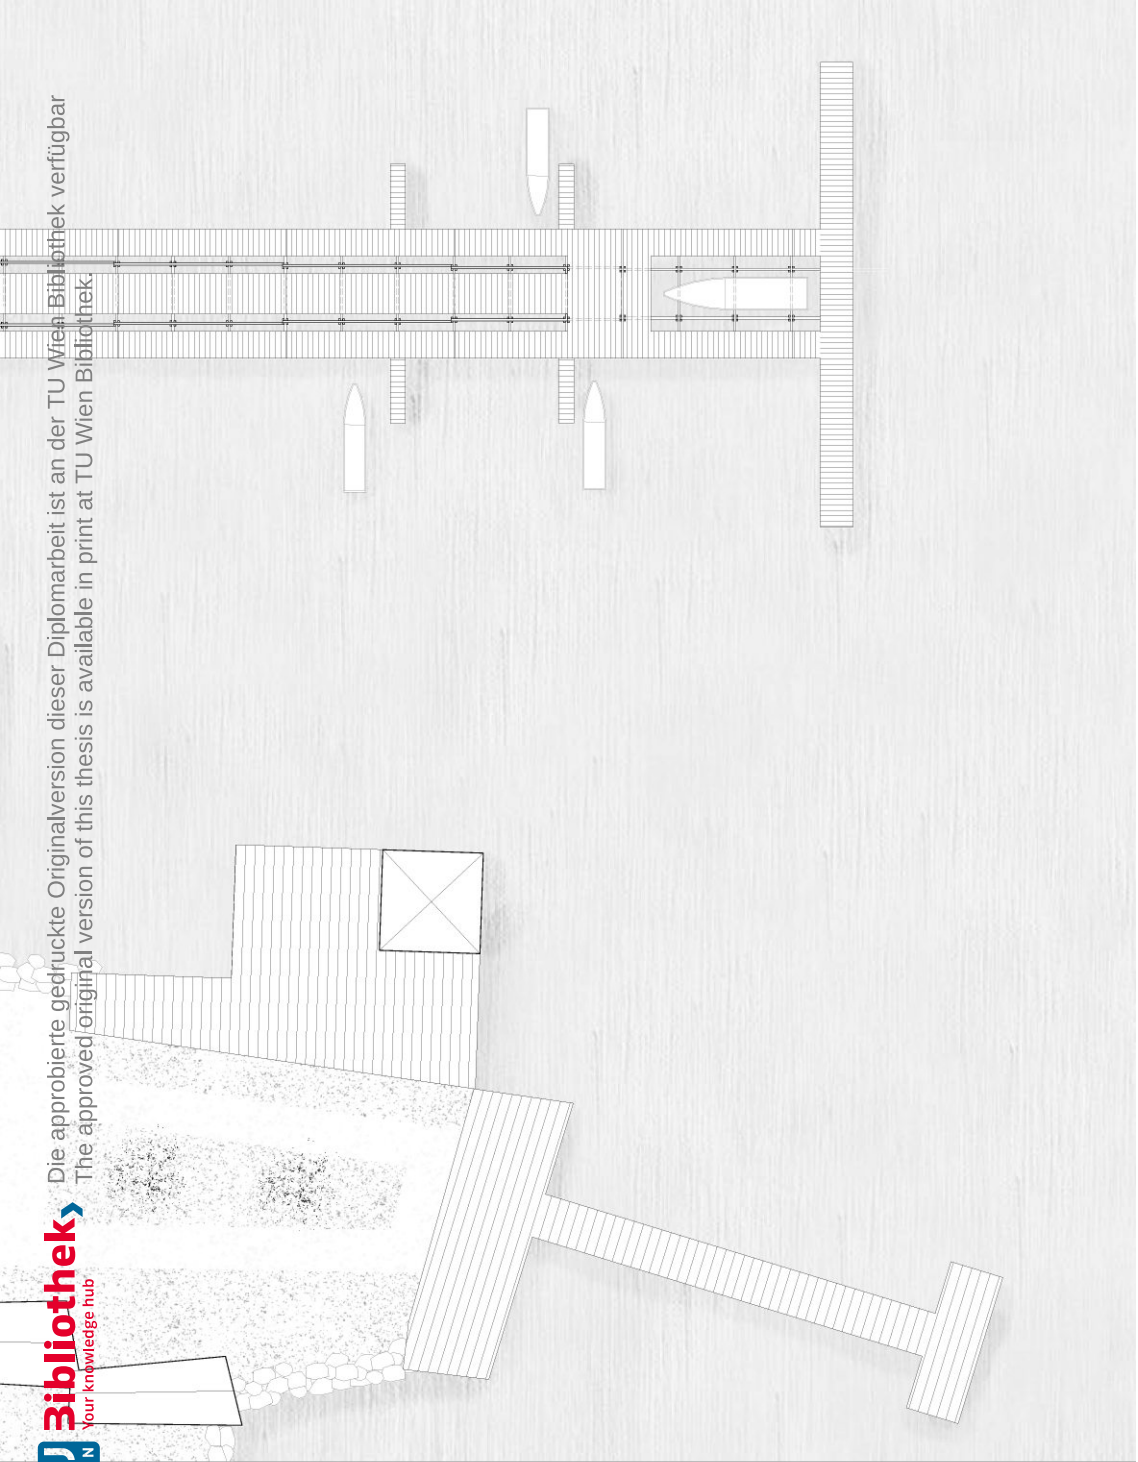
| Grundriss Erdgeschoss. M1:350.
